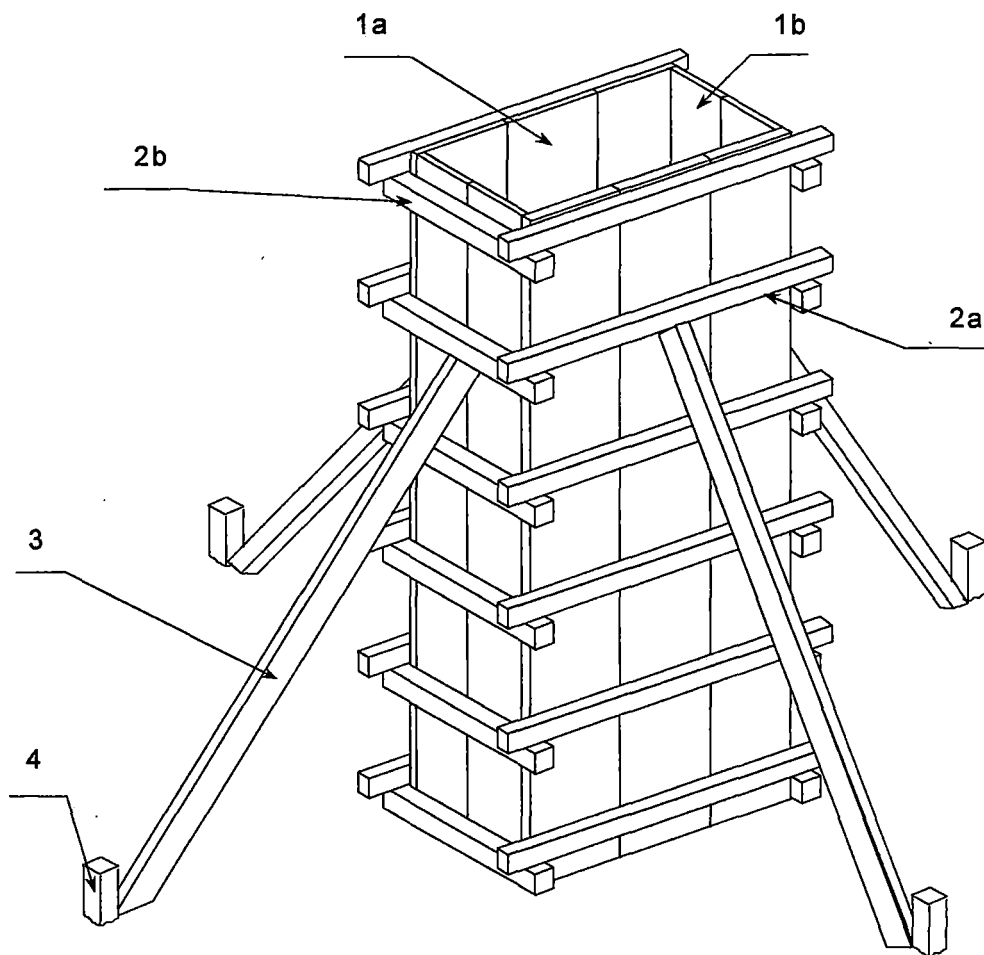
Encofrado de columna de concreto convencional (típica).
